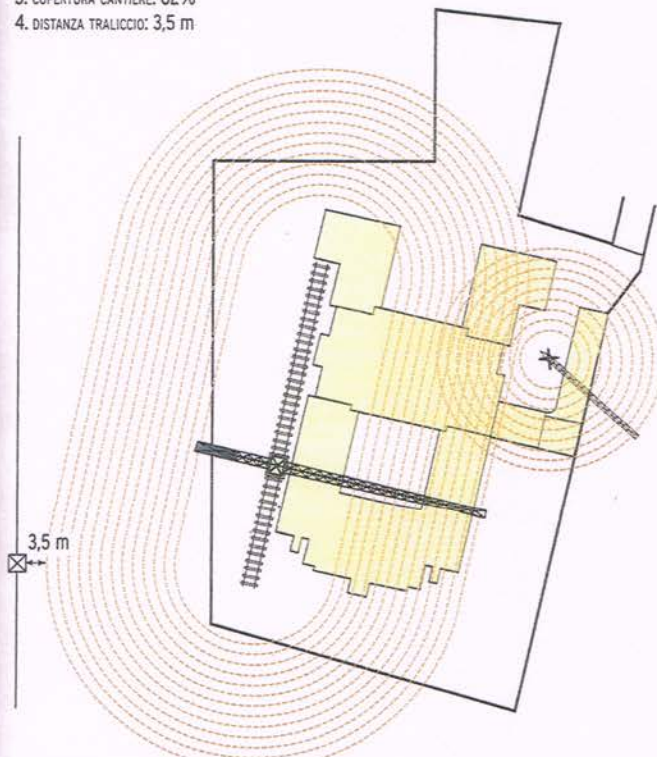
Un impianto tipo di cantiere: una giusta distribuzione delle strutture e dei servizi interni al cantiere è già un ottimo punto di partenza per la conduzione in sicurezza ed efficienza del cantiere stesso. L'obiettivo primario della progettazione dell'area di cantiere è quello di non creare interferenze tra le varie zone di cantiere e le attività in esso previste. È bene che la viabilità interna e gli accessi siano a senso unico e segnalati in modo chiaro ed efficace.
